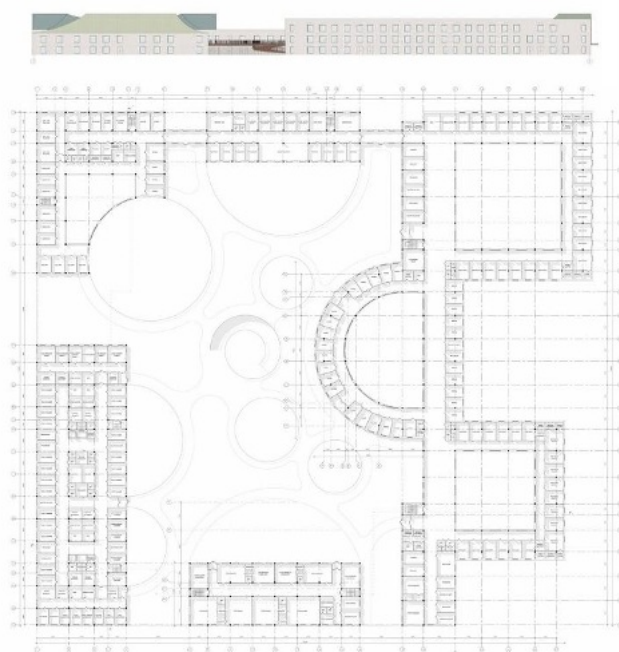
Ветеринарний комплекс в Києві, план 2-го поверху та фасад [19].
